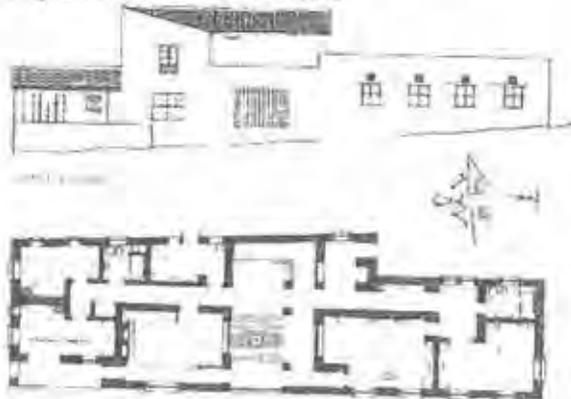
Plan und Fassade von Carr Haus in Licpessi, Griechenland 1964
